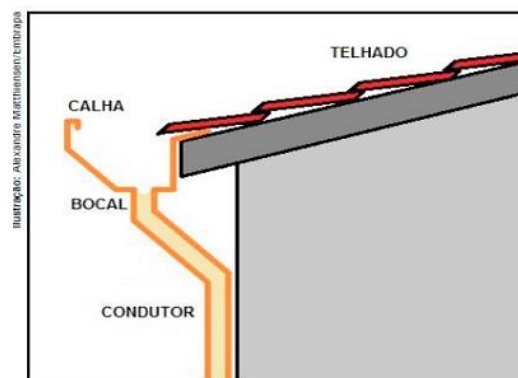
Ilustração de instalação do sistema de calha e tubo condutor
